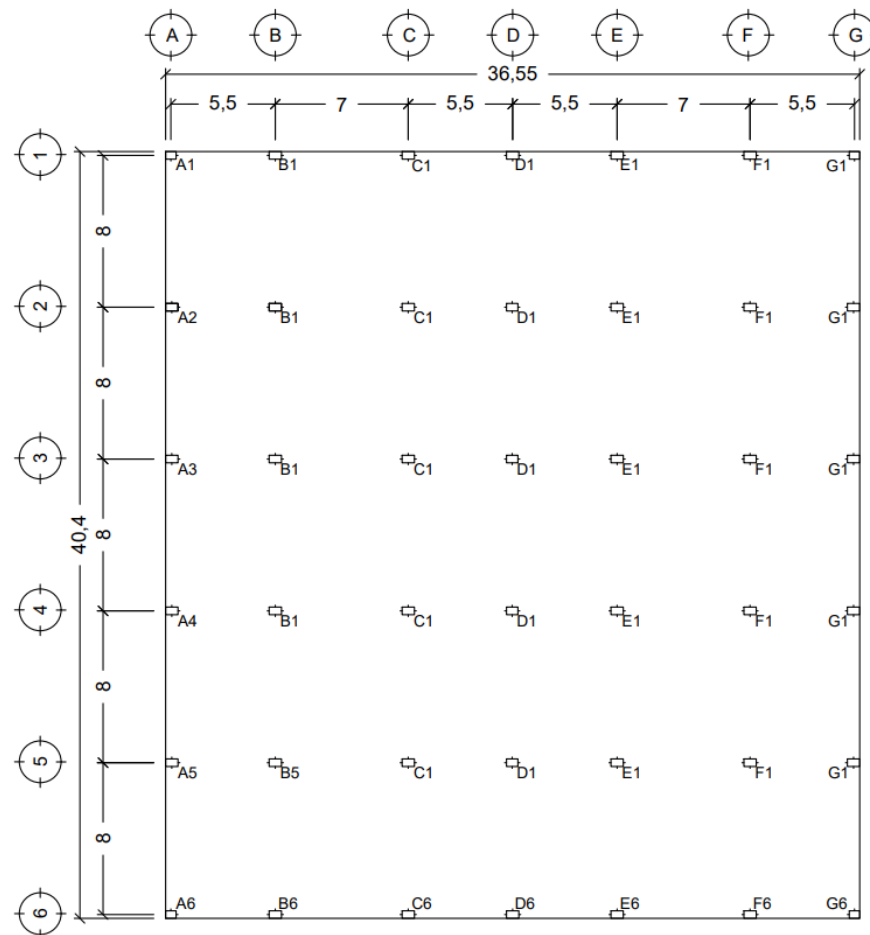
Vista en planta de la estructura. Las columnas se encuentran identificadas por su ubicación en los ejes.
